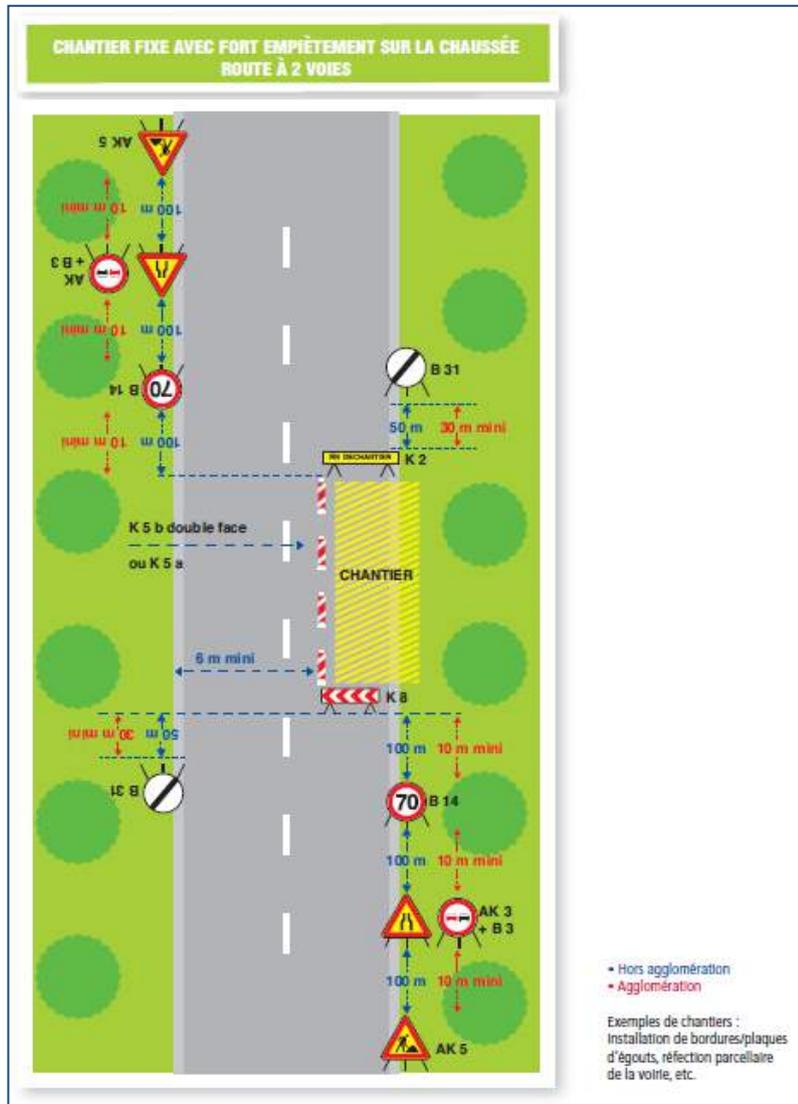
Exemple de signalisation temporaire d'un chantier fixe avec fort empîètement sur la chaussée
